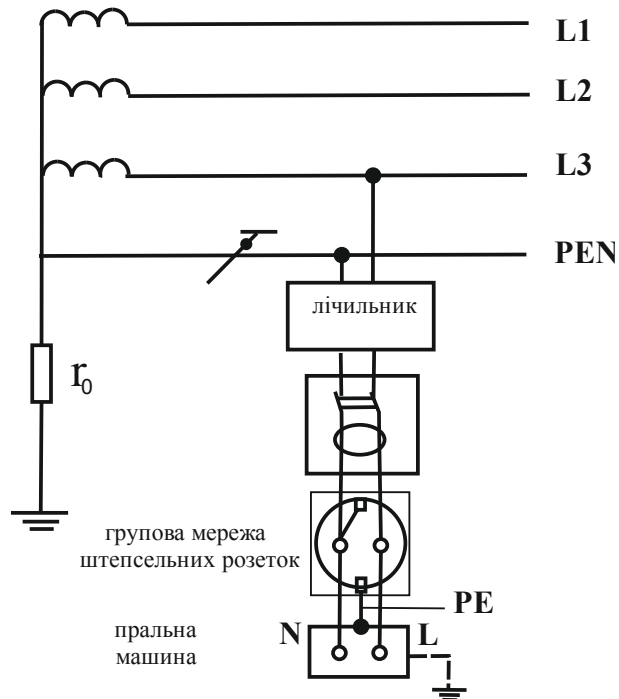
Система TN-С з приєднанням корпусу електроустановки до нейтралі джерела живлення через вивід в розетки
